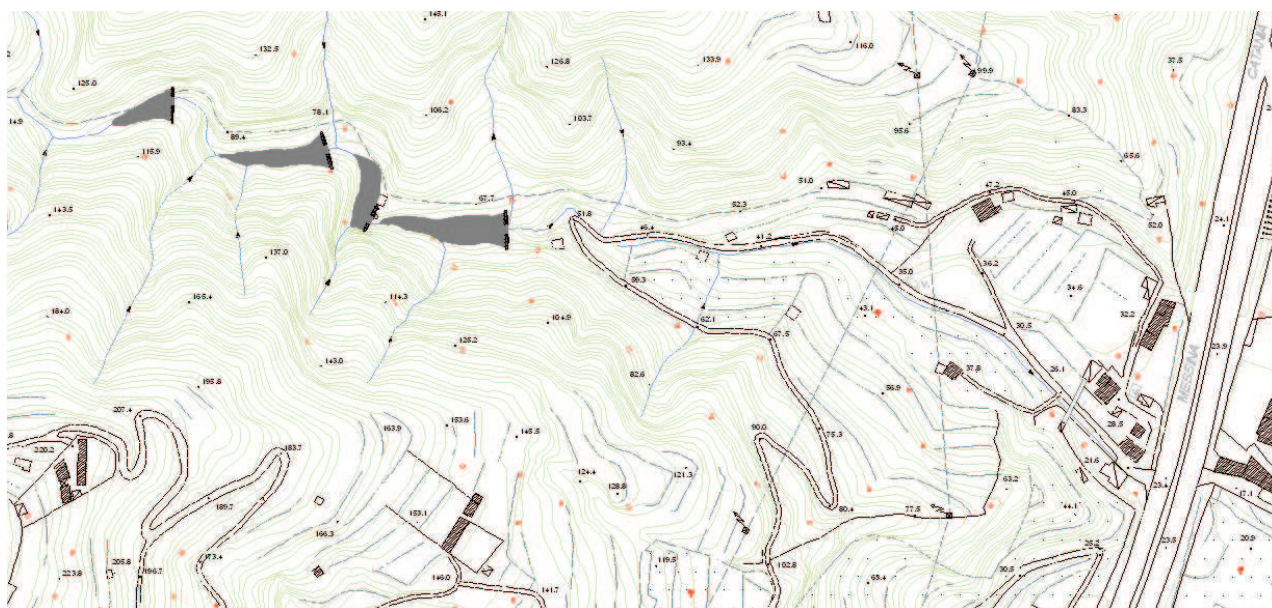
Estratto della planimetria di progetto con l'ubicazione delle briglie di sistemazione dell'asta.
